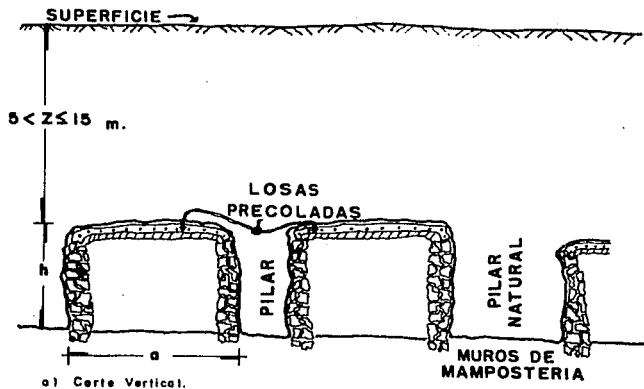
Estabilización a base de muros de carga y colocación de losas de concreto precoladas.
